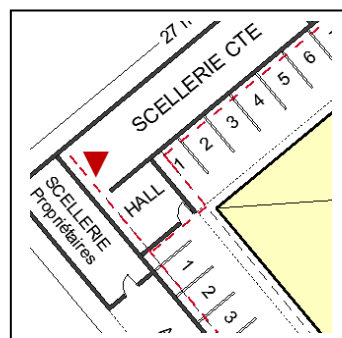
Angle des 2 ailes de stabulation + entrée Hall (accueil bombes et harnais)
